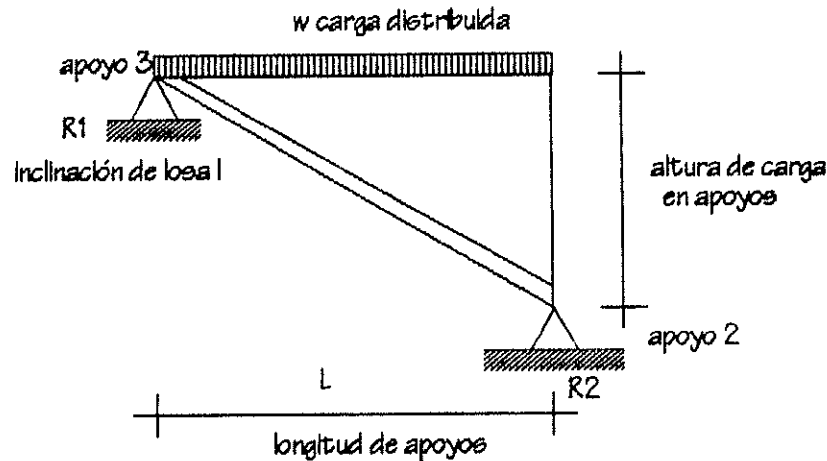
(Distribución de cargas en los apoyos en losas inclinadas)
